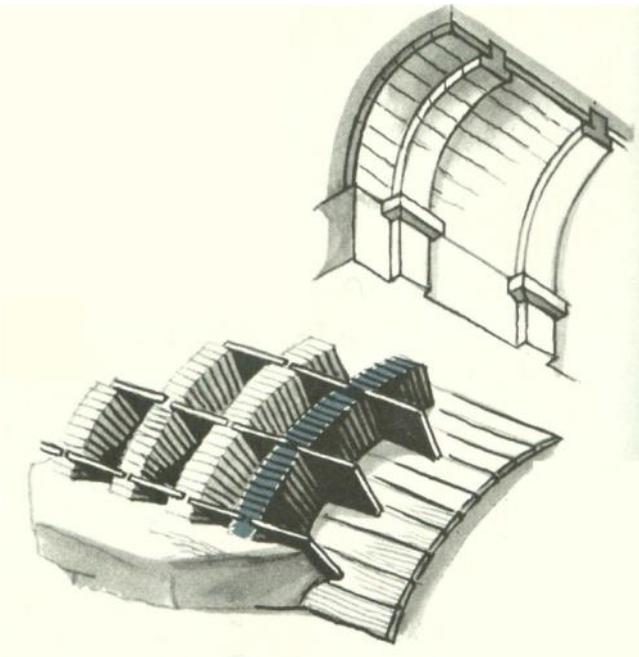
Método Construtivo. Abóbada de berço. Arranjo de tijolo cozido sobre cimbre de madeira para receber concreto.
